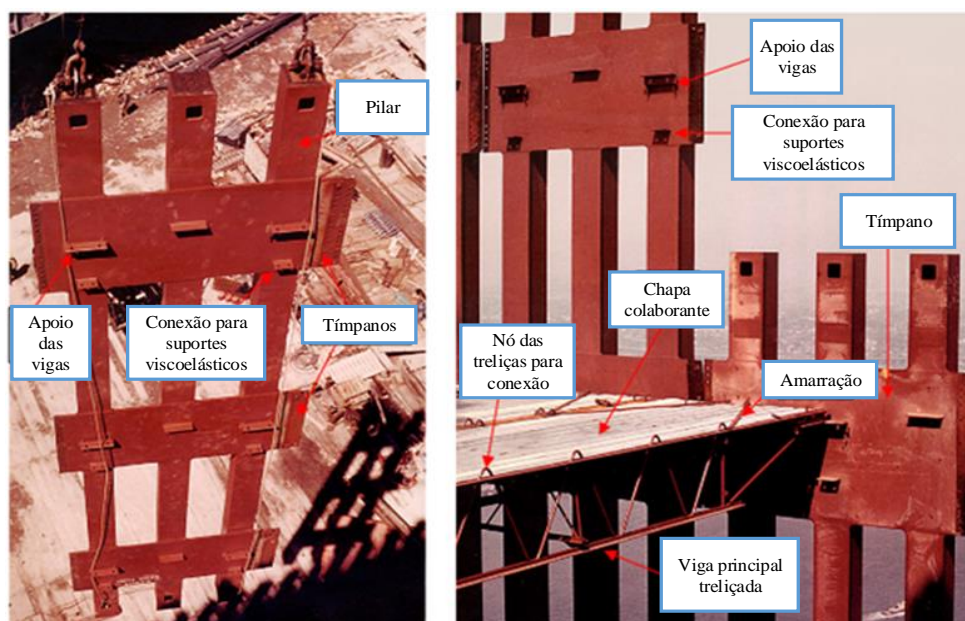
Elementos estruturais pré-fabricados das fachadas e pisos do antigo WTC (adaptado de NIST (2005)).
